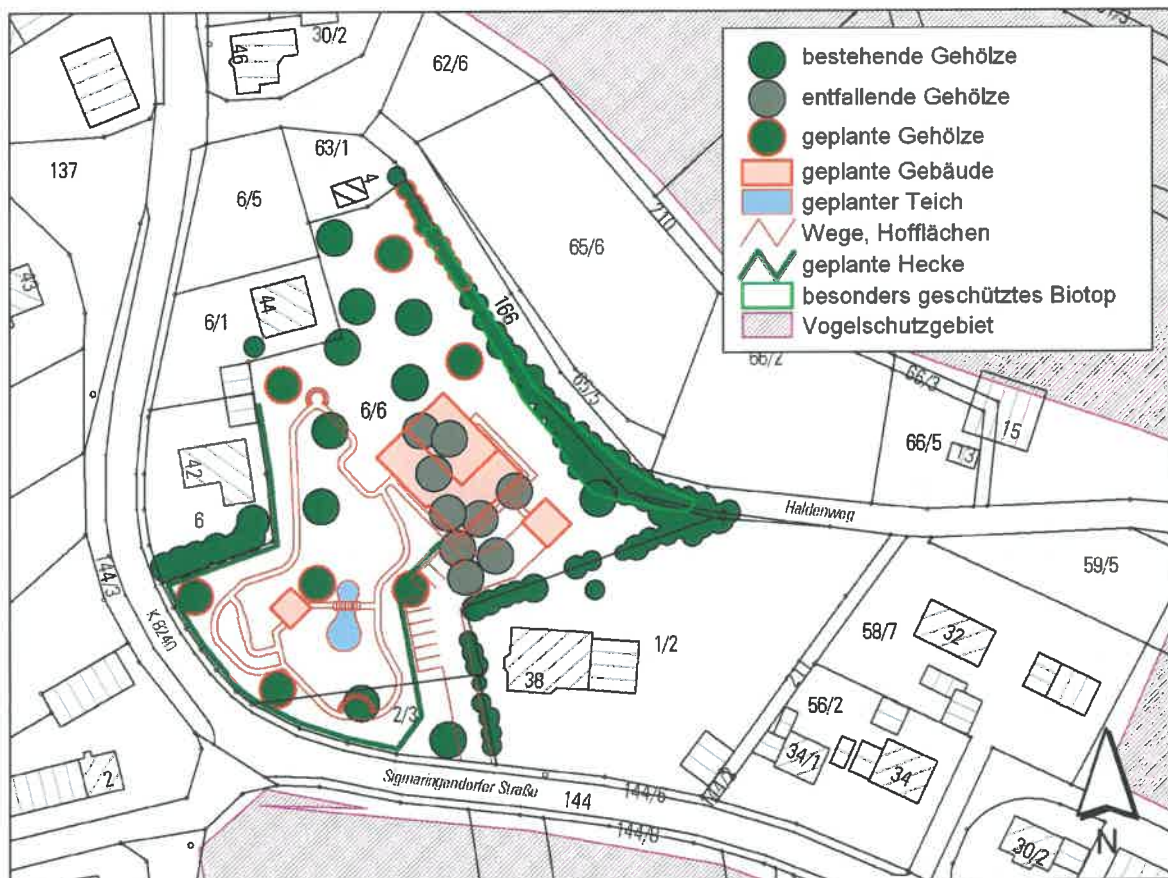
Lageplan mit geplanter Eingrünung (M 1:1.500)
